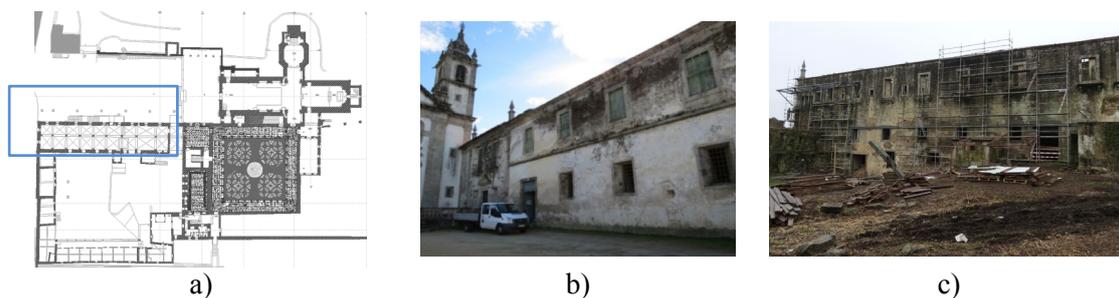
a) Planta geral com área de intervenção a azul, b) alçado exterior e c) alçado interior.
